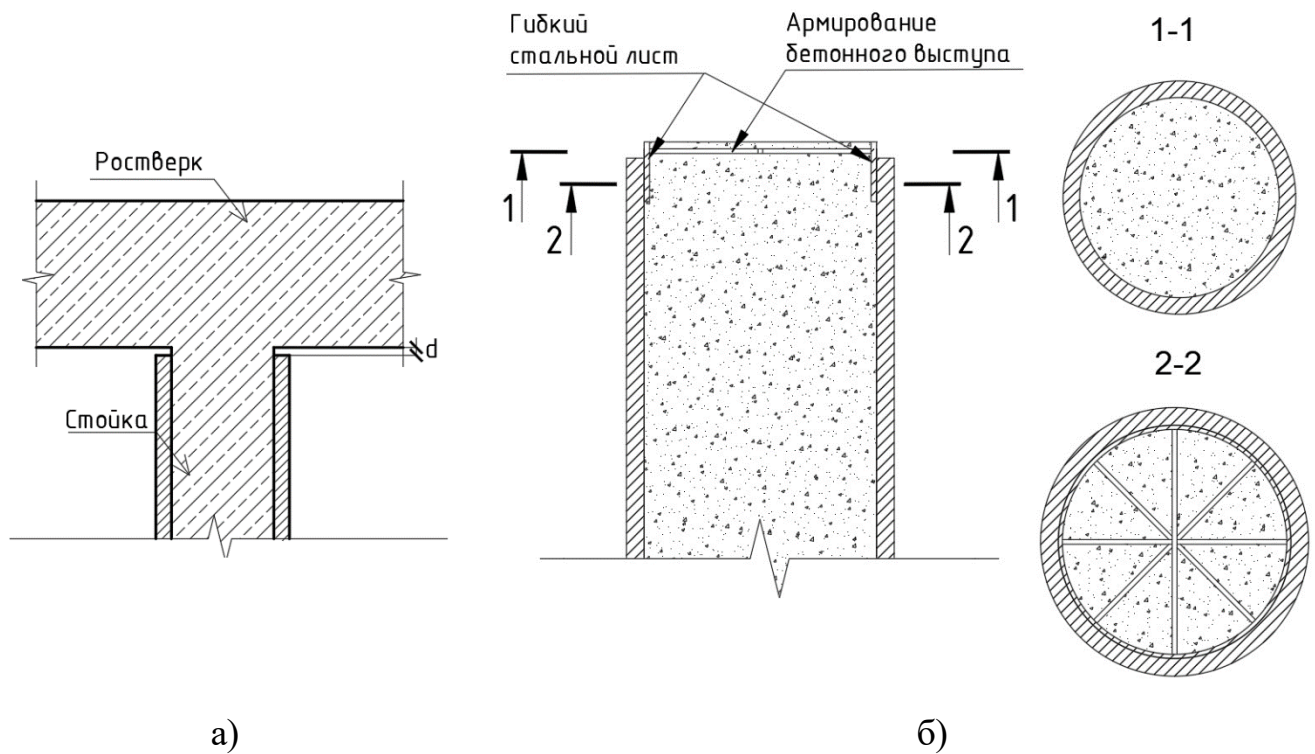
Принципиальная схема: а) сопряжения стойки с ростверком; б) усиления оголовка предварительно напряженной трубобетонной стойки
